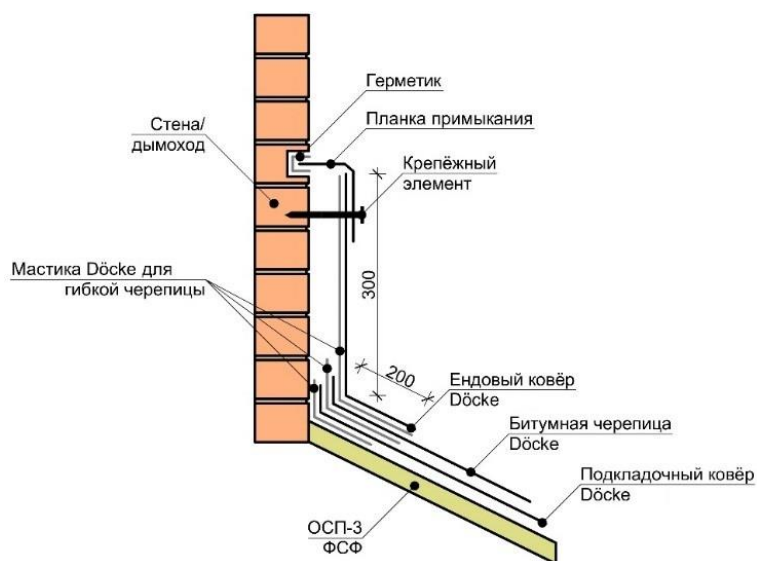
Примыкание ската крыши к выступающим над ней конструкциями под углом более 120°
